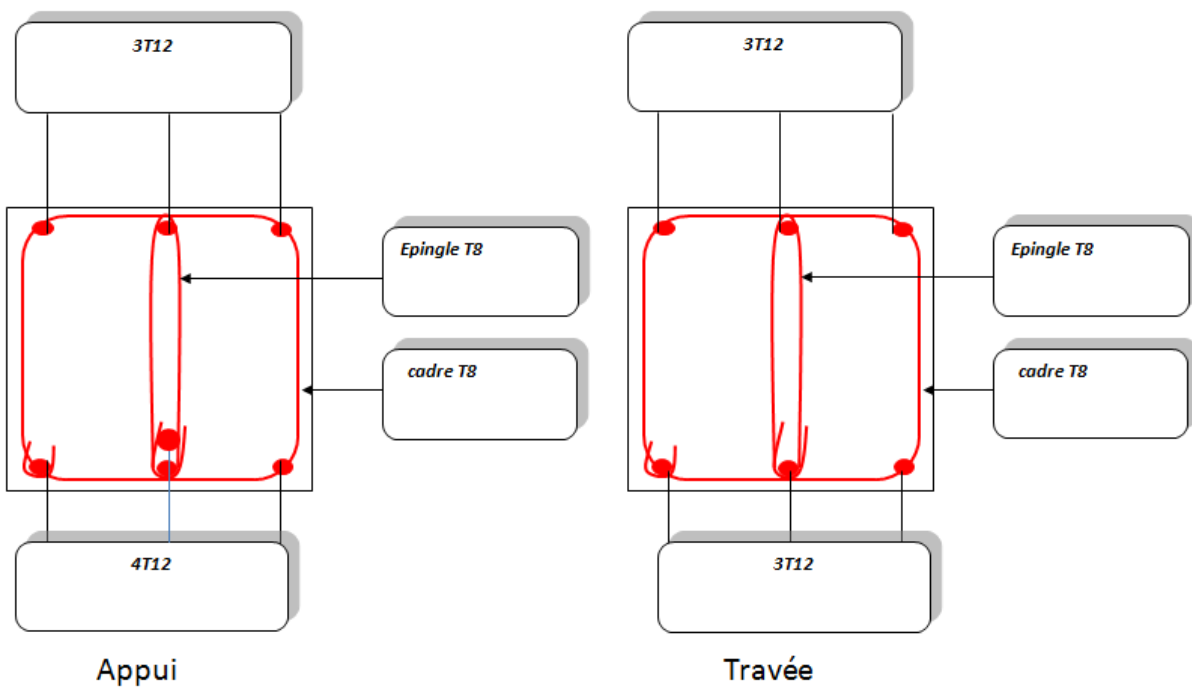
Ferrailage de la poutre palière en appui et en travée
